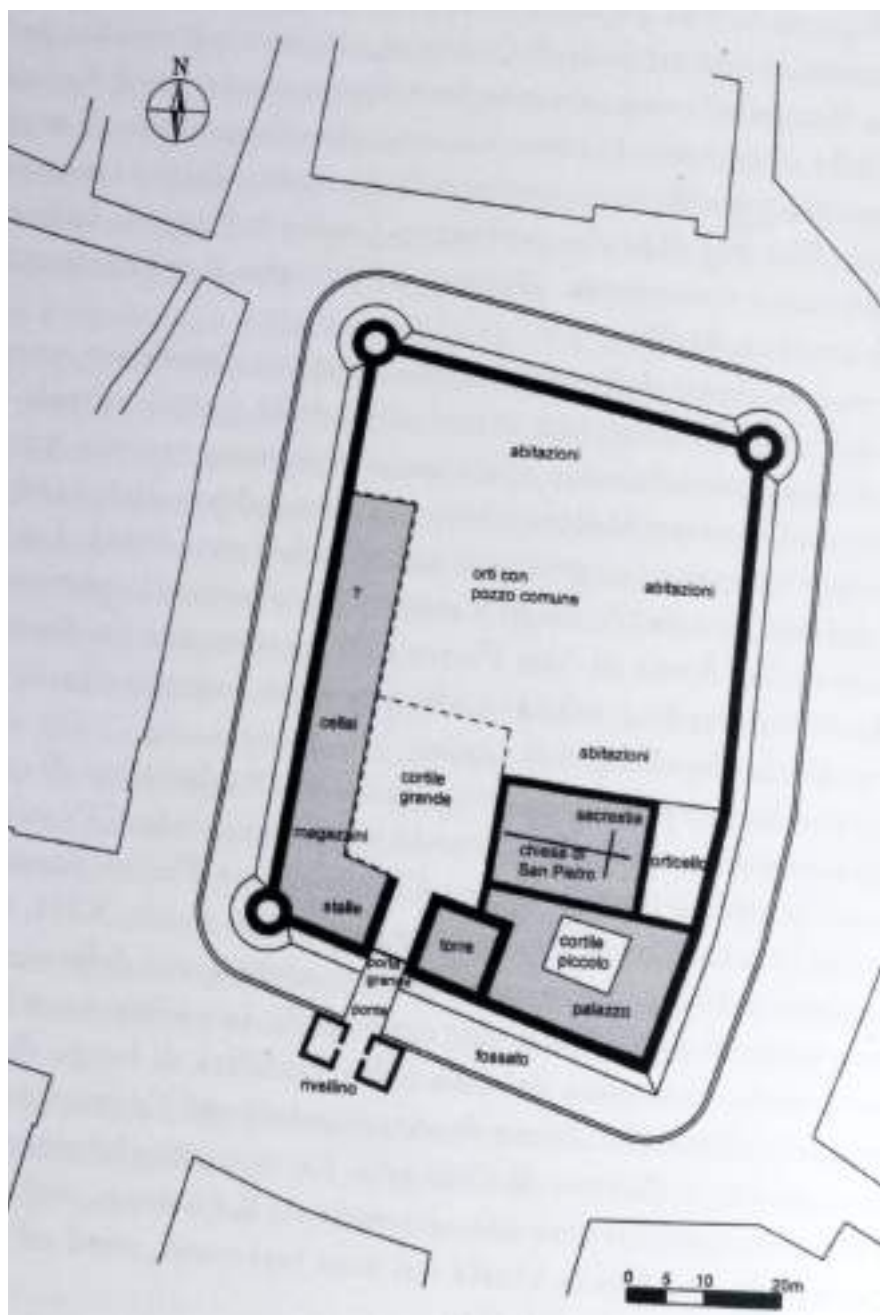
Ricostruzione planimetrica del castro nel 1515 (da D. CAPOLONGO, *Storia* cit.).
